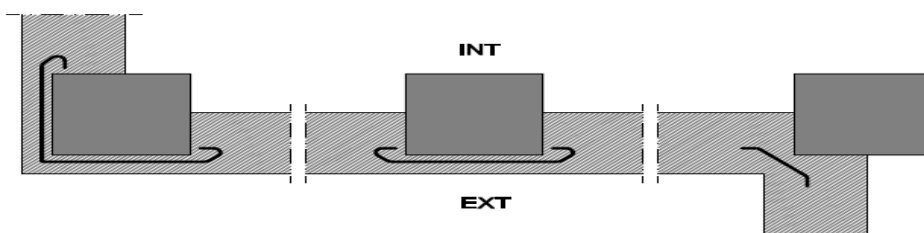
Ejemplo de encuentro de la fachada con los pilares
